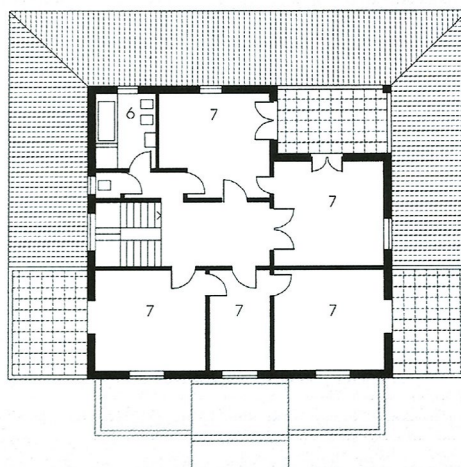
Configuração inicial. Planta baixa do primeiro pavimento. Distribuição mais rígida, balcões e telhados cerâmicos.⁷
